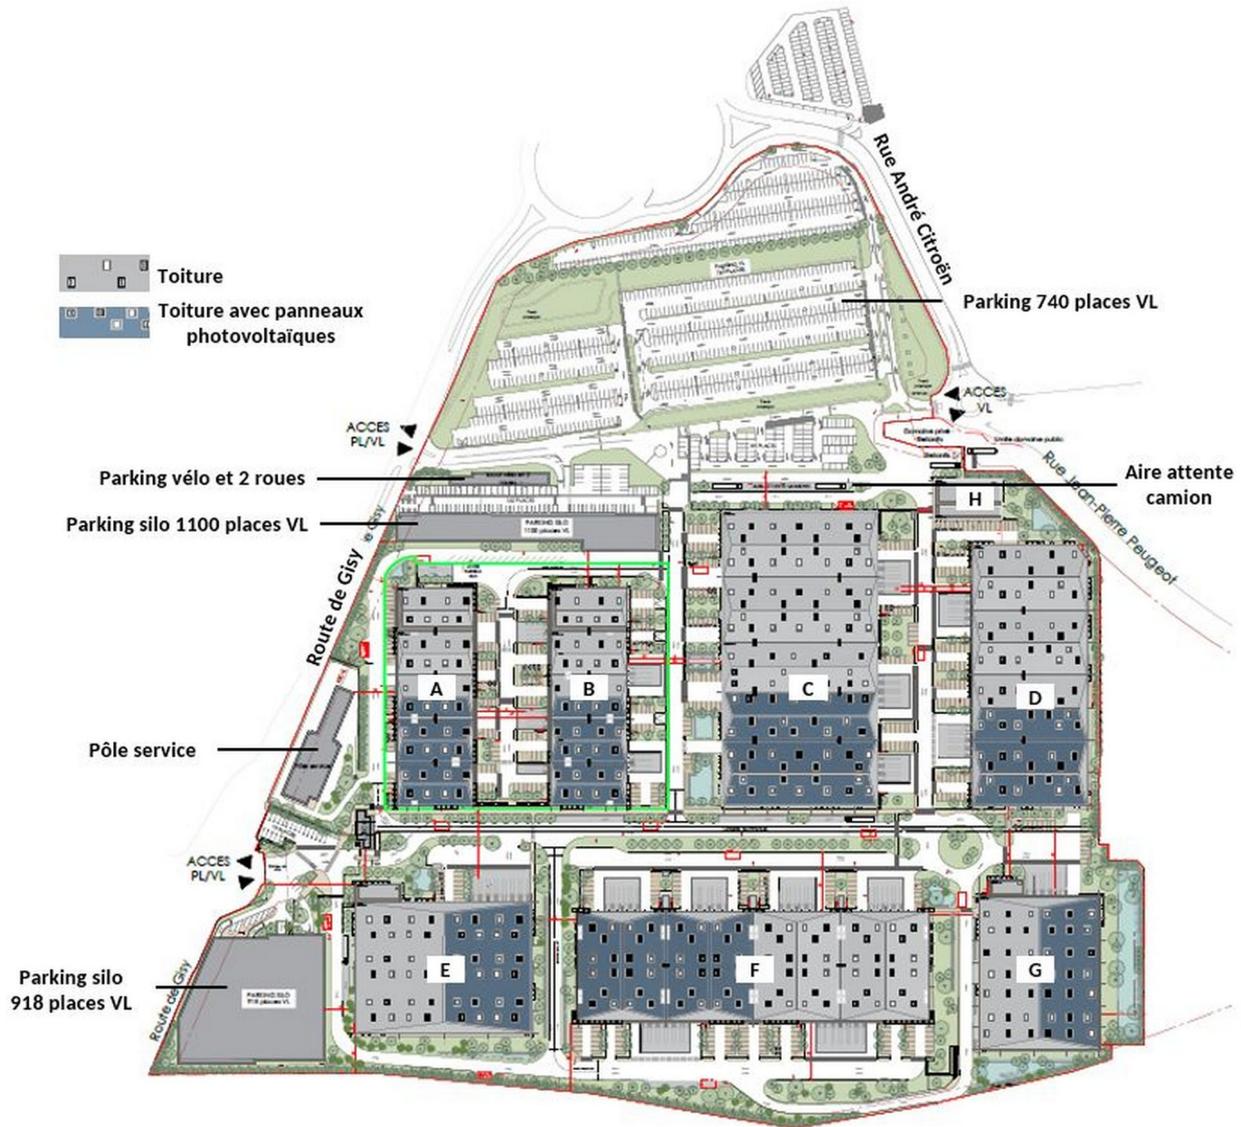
Plan de masse du projet. La zone entourée en vert clair correspond au secteur 1. Les bâtiments C, D et H sont dans le secteur 2, les bâtiments, E, F et G sont respectivement dans les secteurs 3, 4 et 5. (PC2.10-plan masse projet général secteur 1, indications ajoutées par la MRAe).
